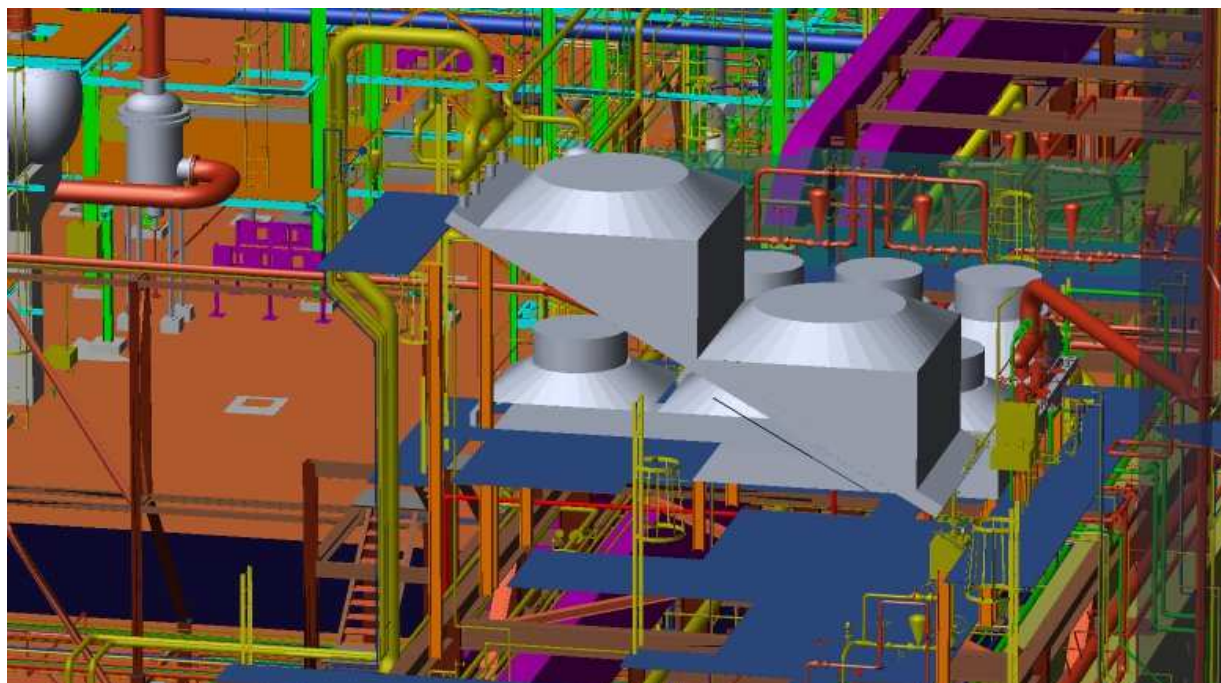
Disposición de Tuberías Alrededor de Aerorefrigerantes sobre el Pipe Rack
